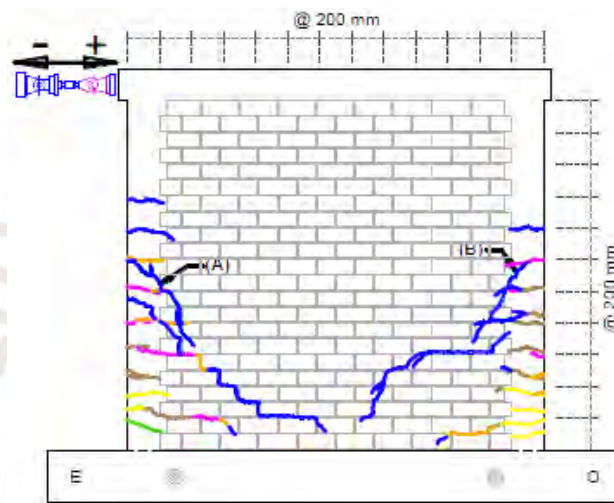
Aparición de fisuras y grietas en el muro confinado en la Fase 7 del ensayo [19].
